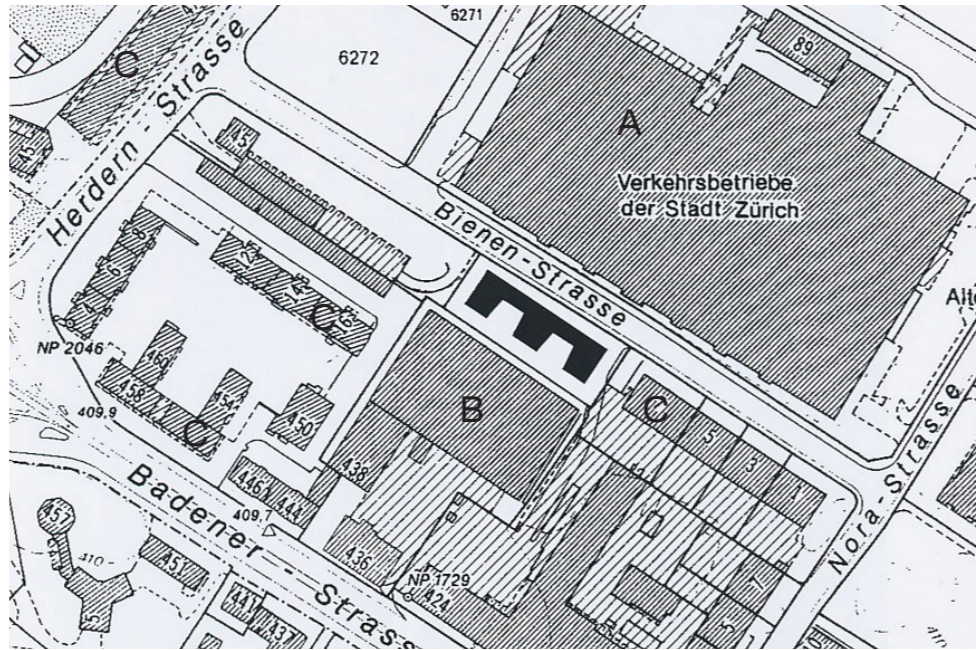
genehm. Lageplan der Referenzgen. Bebauung. A: Tramdepot, B: Fabrik, C: Wohnblöcke
